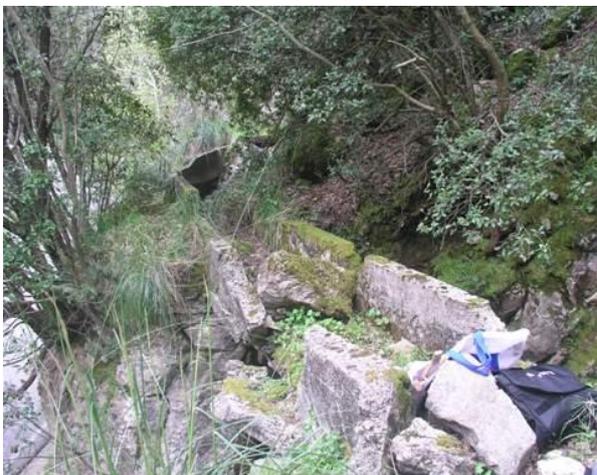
Canale di derivazione tra i picchetti 20 - 21: vista del ponte canale in affiancamento alla strada provinciale S.P. n. 125
